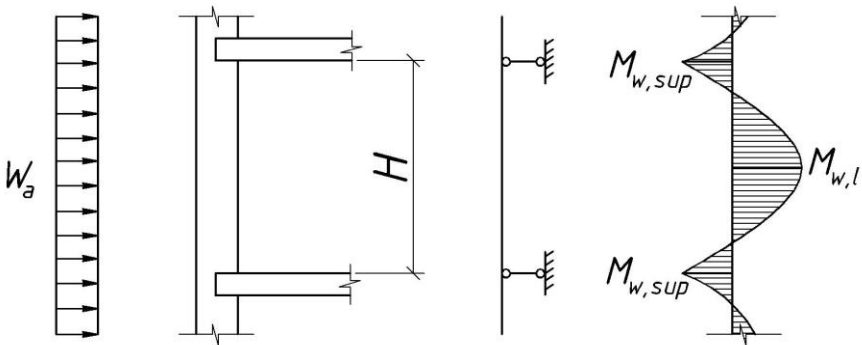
Розрахункова схема стіни при дії місцевого вітрового навантаження
